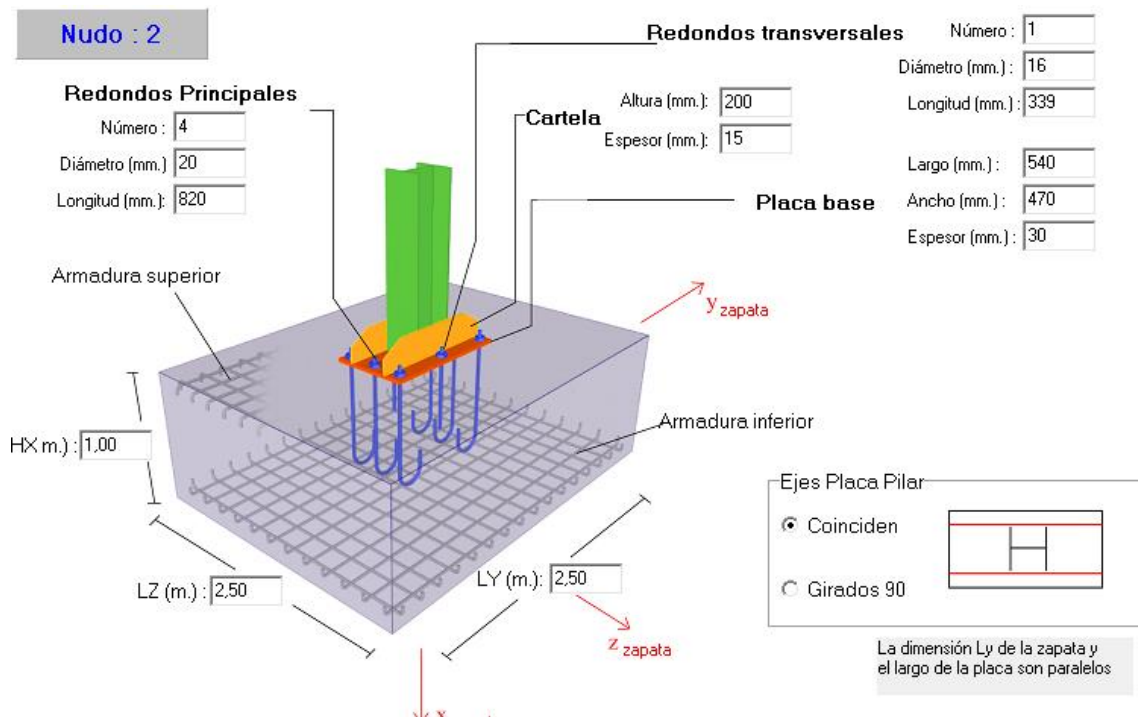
Detalle zapata tipo 2 (Nudo 2). Fuente: Metalpla XE 64
